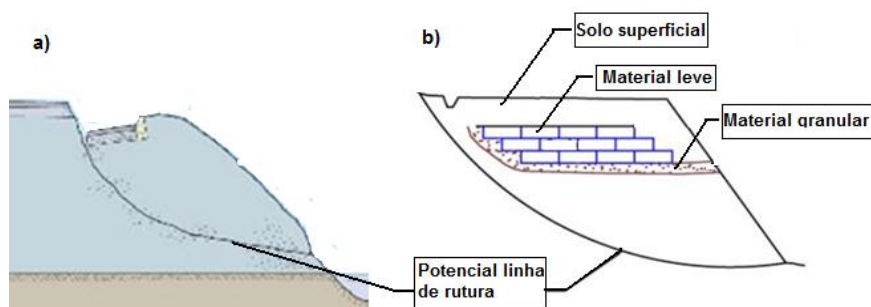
Construção de aterro leve permite reduzir as ações horizontais nas fundações adjacentes
